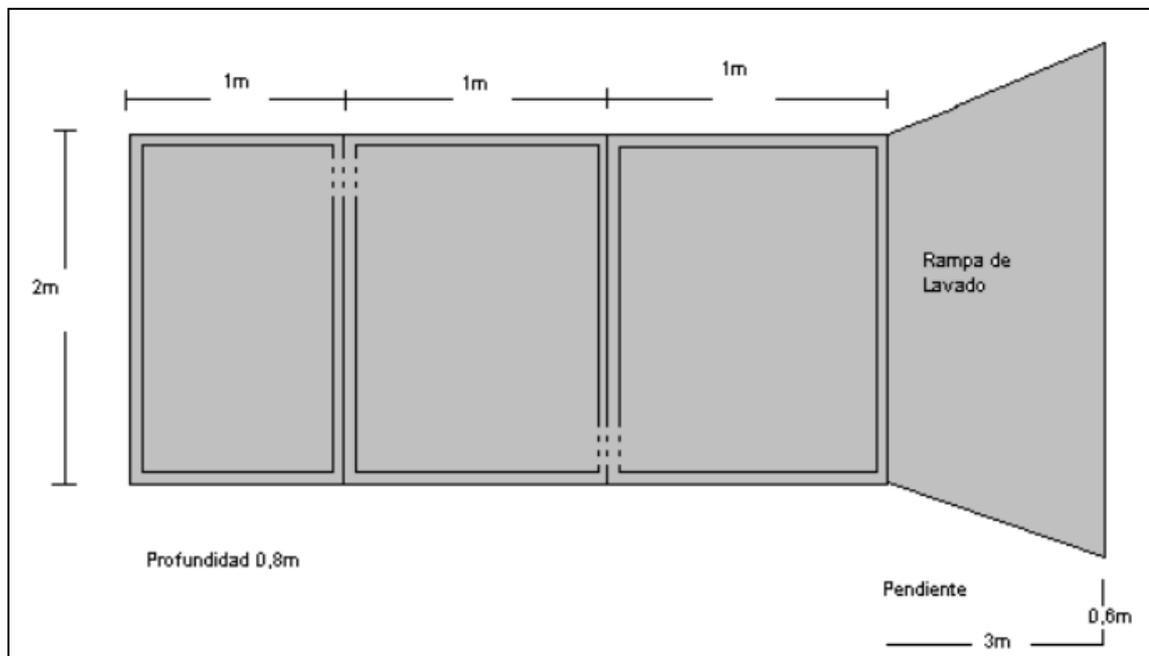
Esquema de las piletas de lavado de equipos de hormigón
